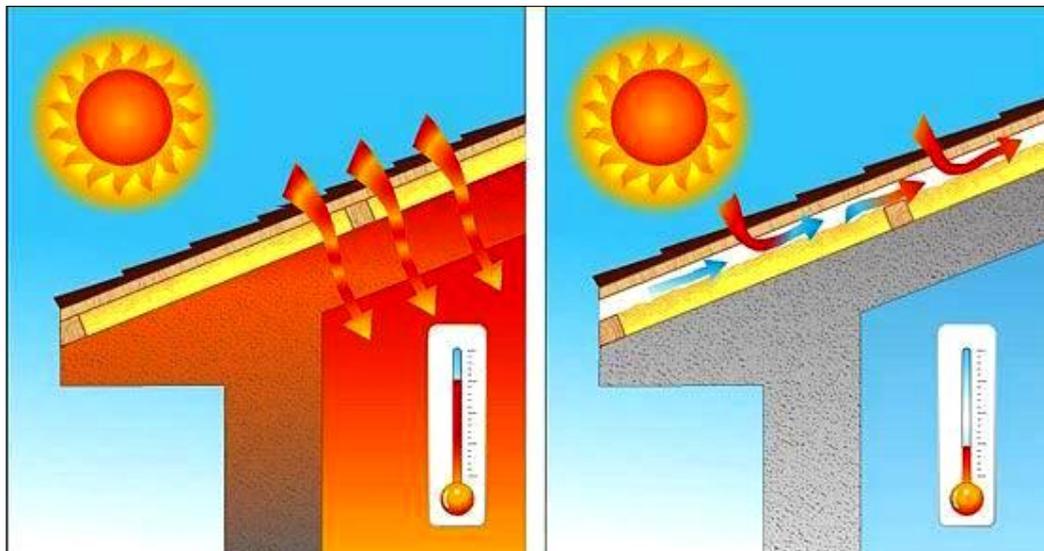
Sistema de ventilação sob telhado utilizando telhas do tipo *Shingle*.
